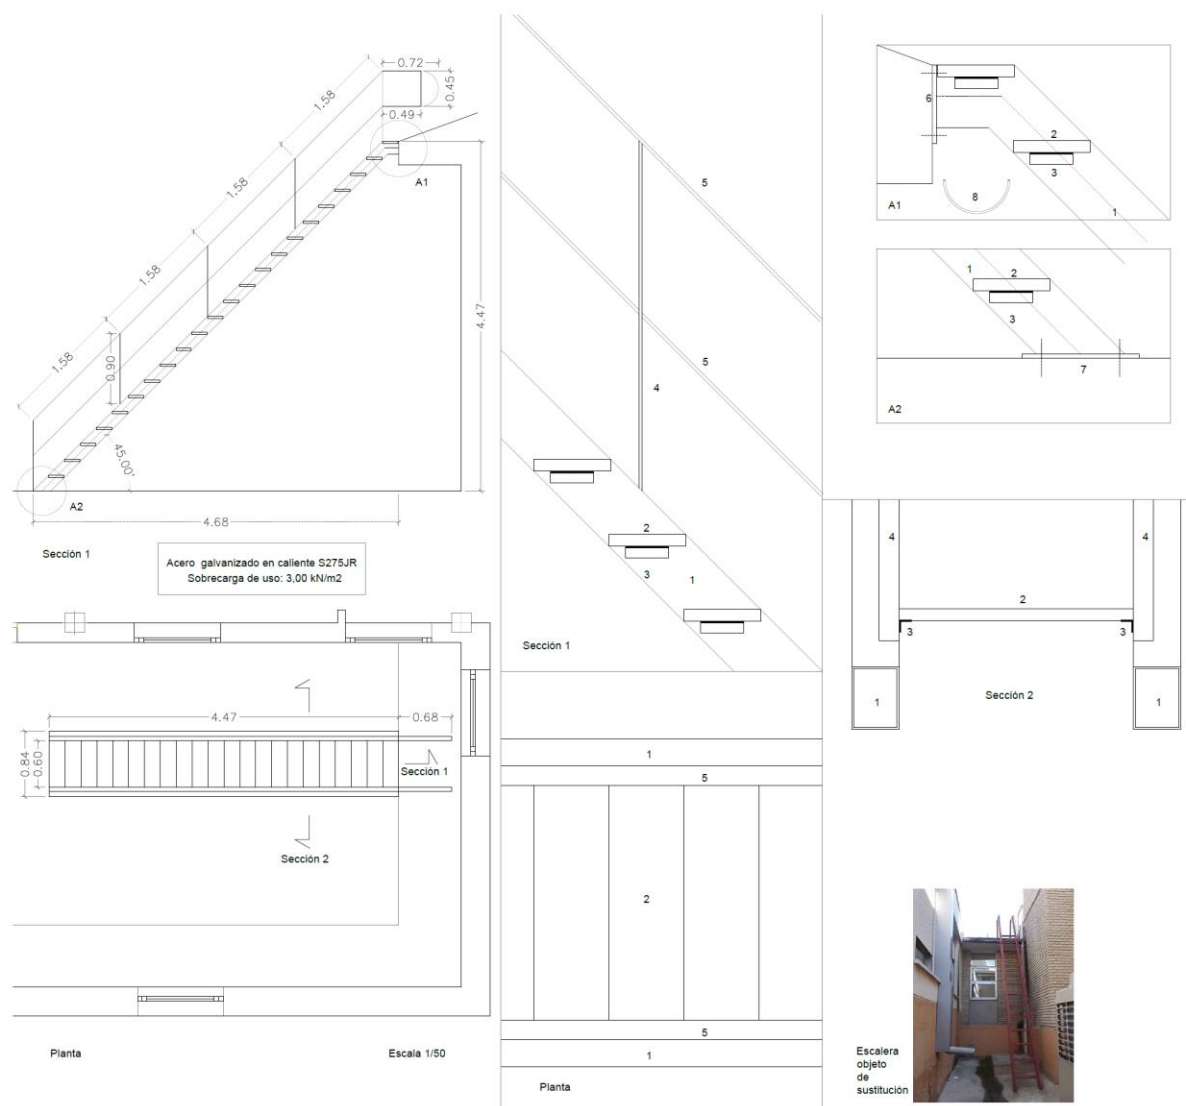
ESCALERAS DE ACCESO A CUBIERTA
